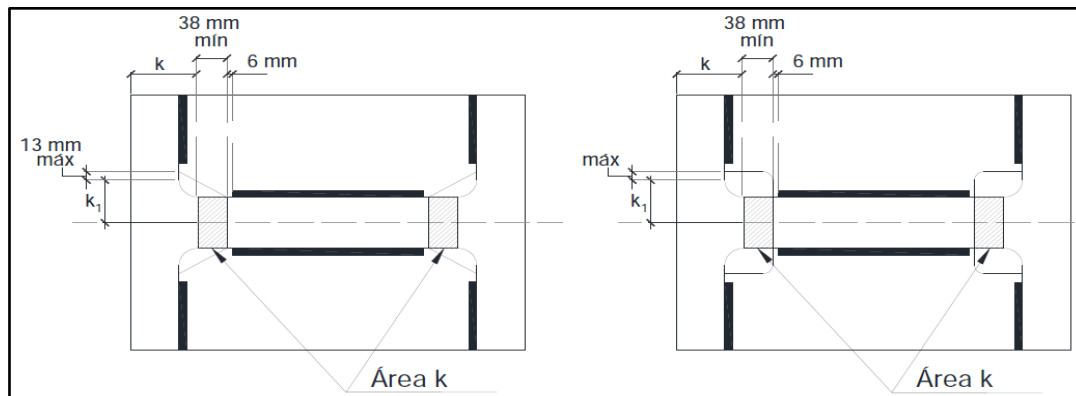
Recortes en placas de continuidad en columnas. NEC-SE-AC (2015)
